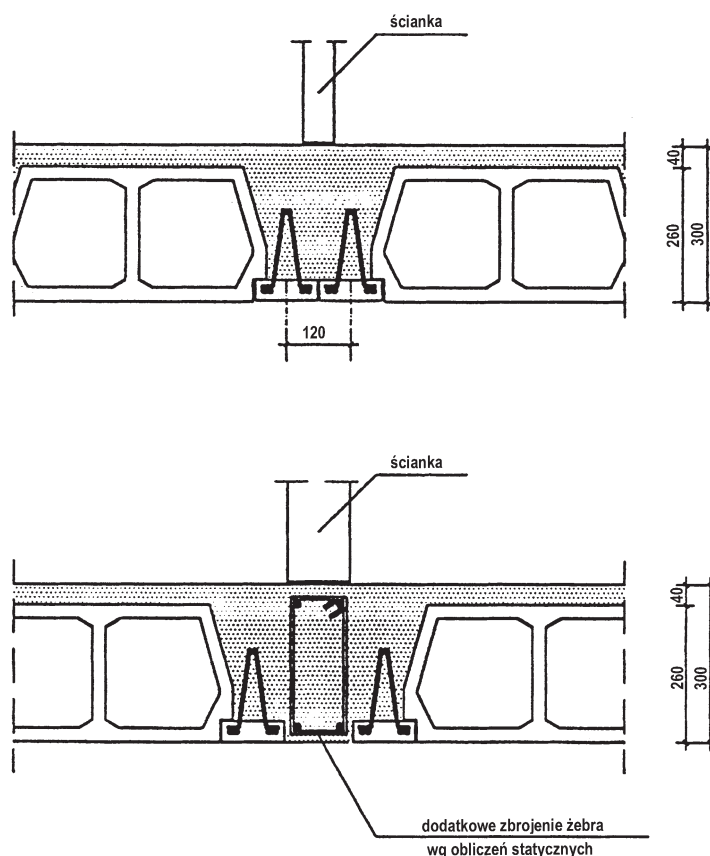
Przykład przekroju przez żebro rozdzielcze.
